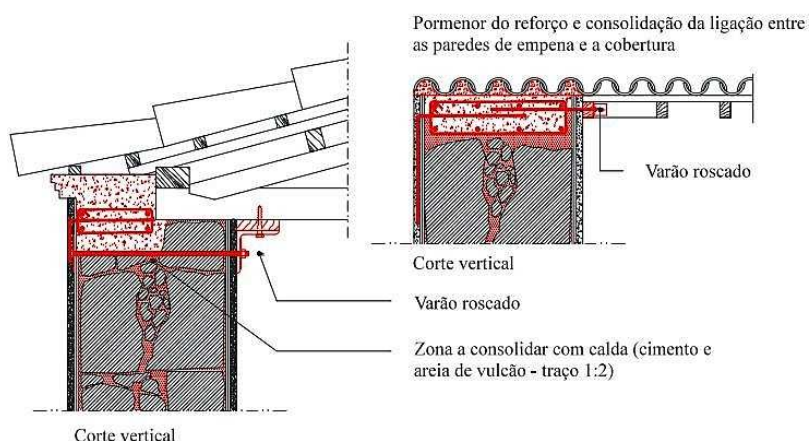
Reforço com vigas em betão no coroamento das paredes. [40]
